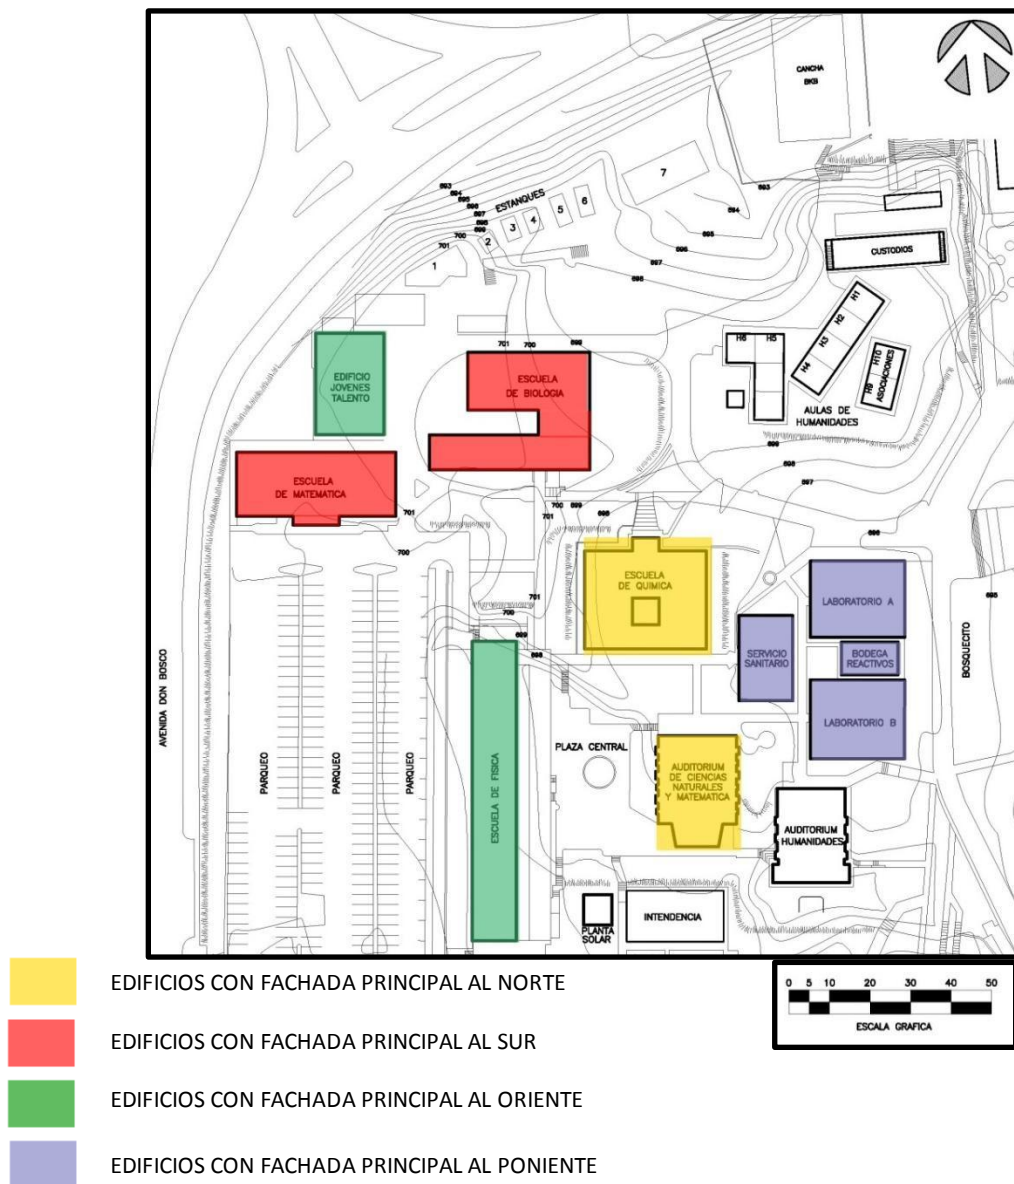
PLANTA CON ORIENTACIÓN DE FACHADAS EN EDIFICIOS
